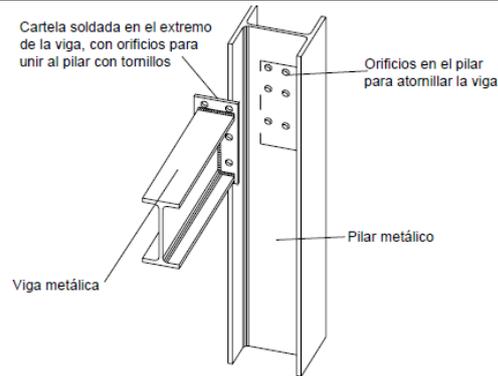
Unión entre pilar y viga. Fuente: Brotóns (2010)
